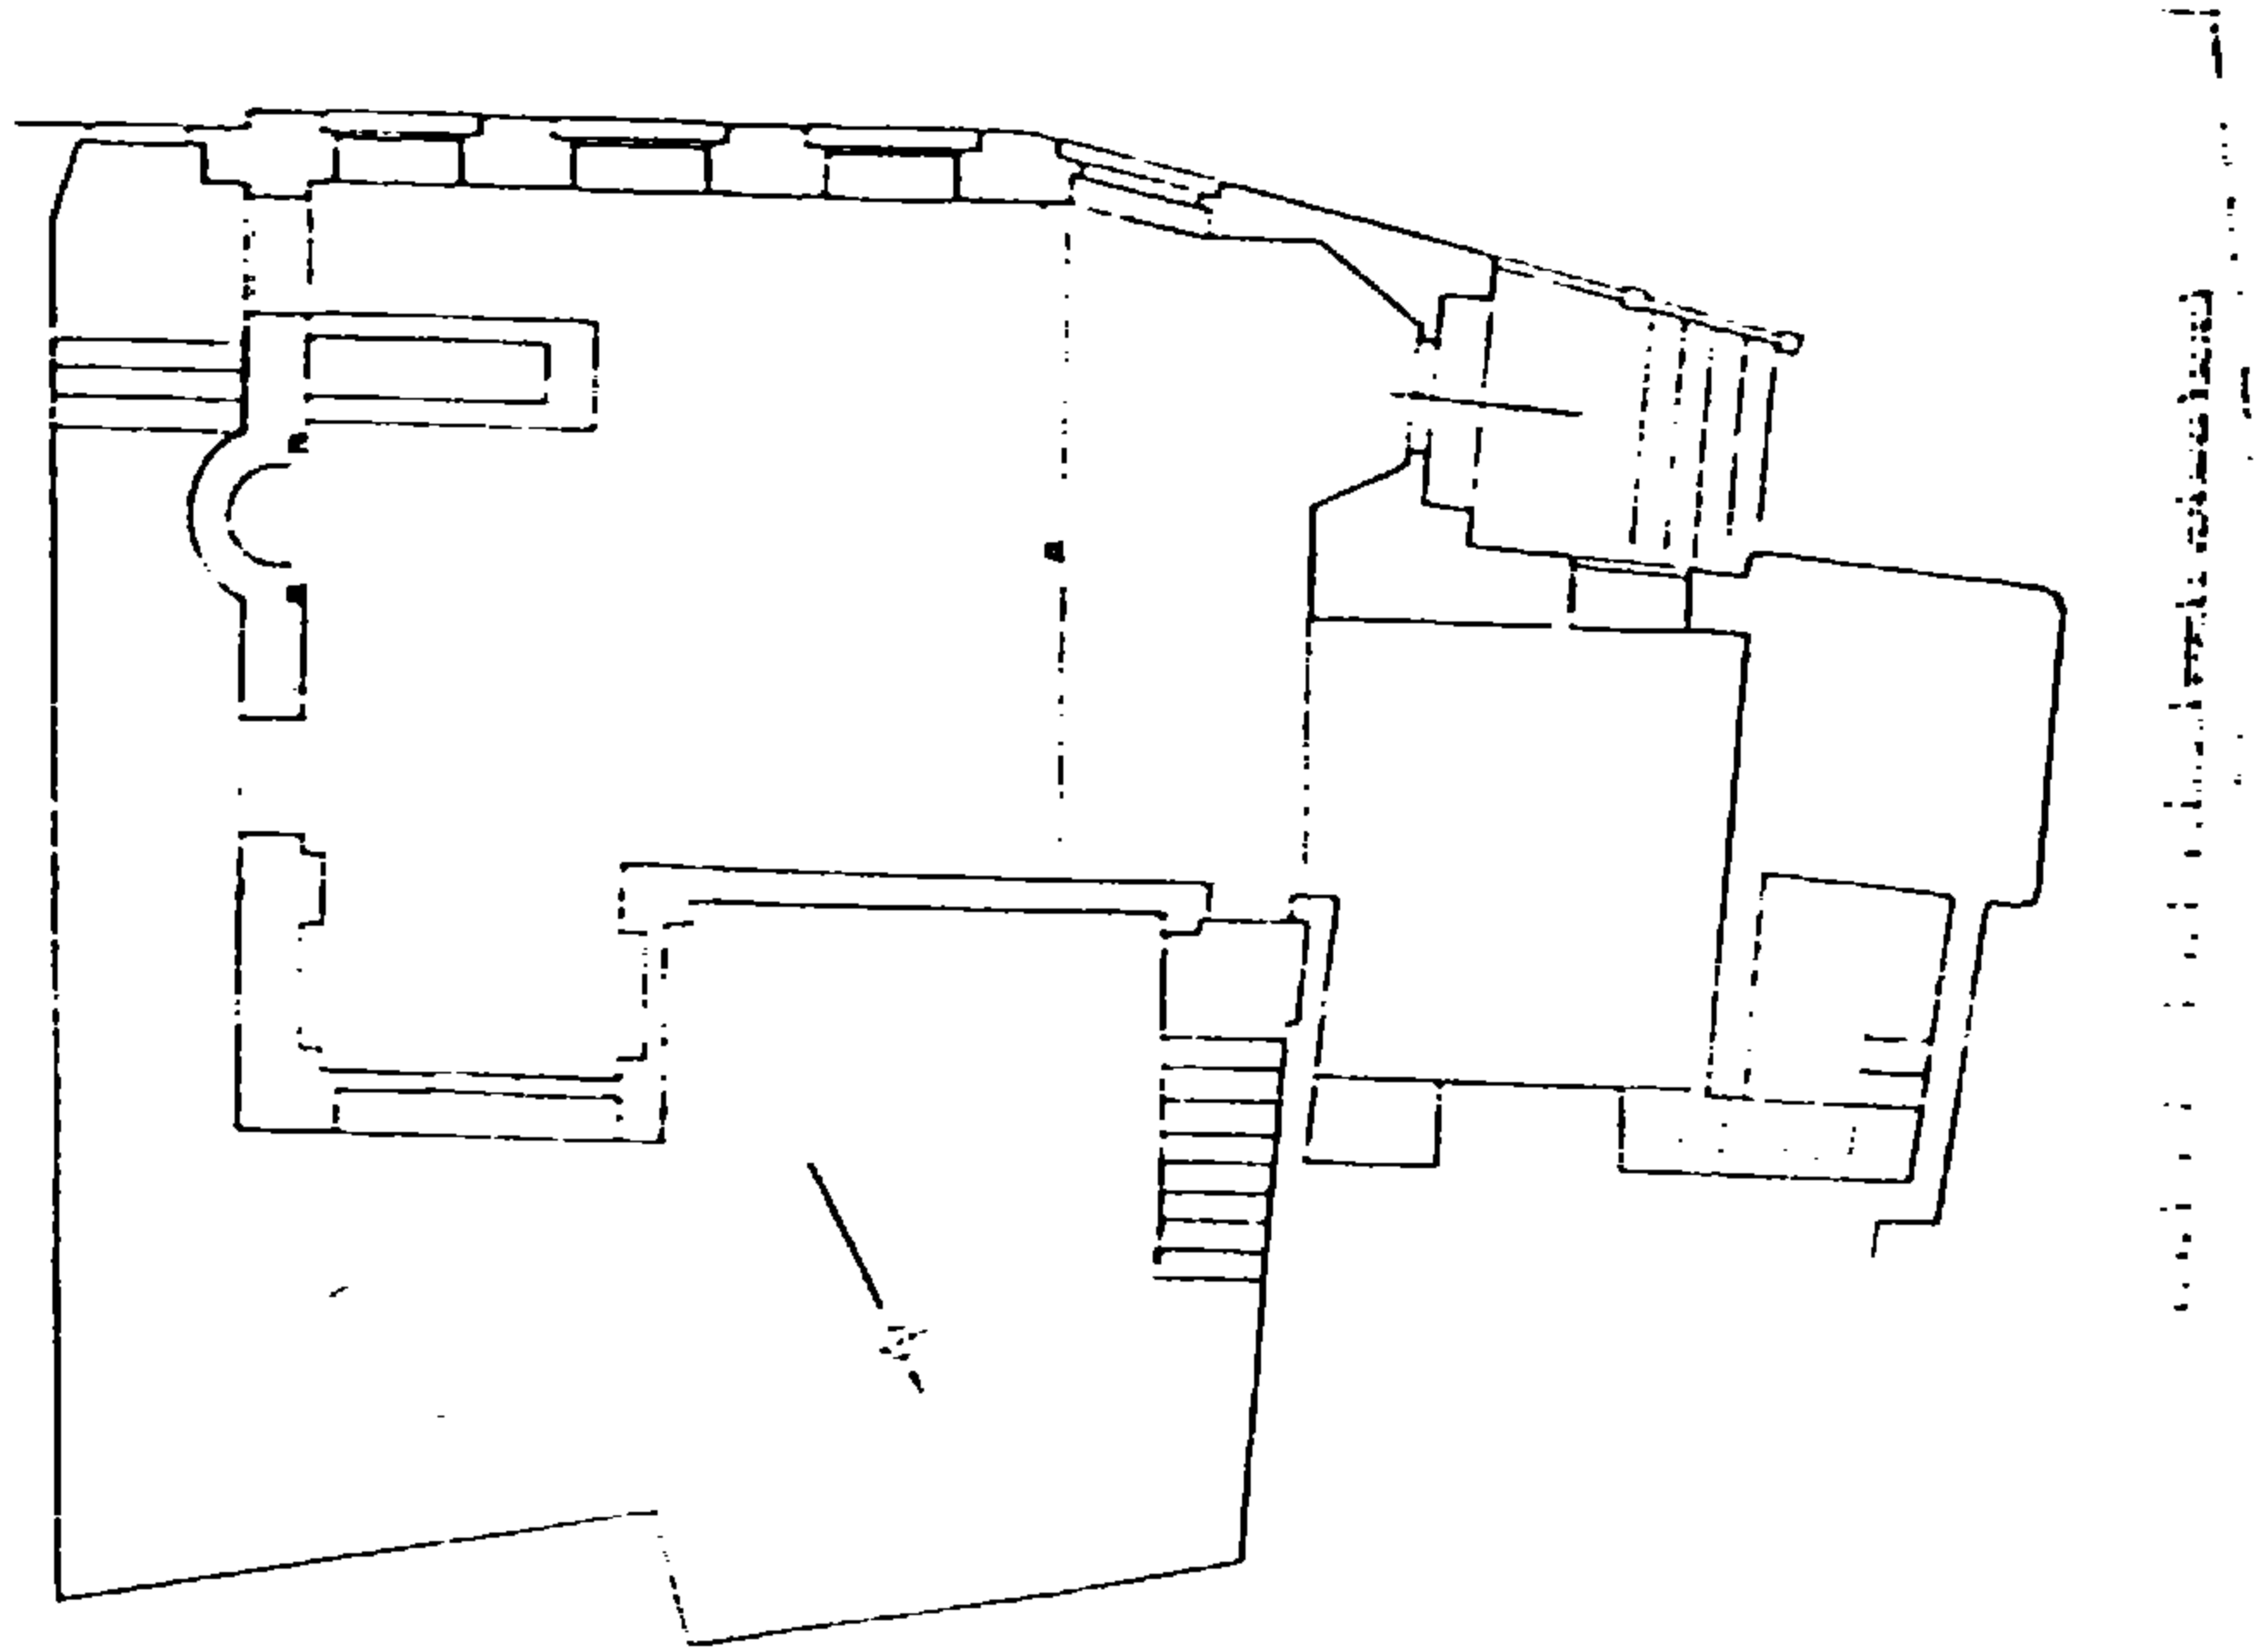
المسقط الأفقى لجامع الشواذلية
